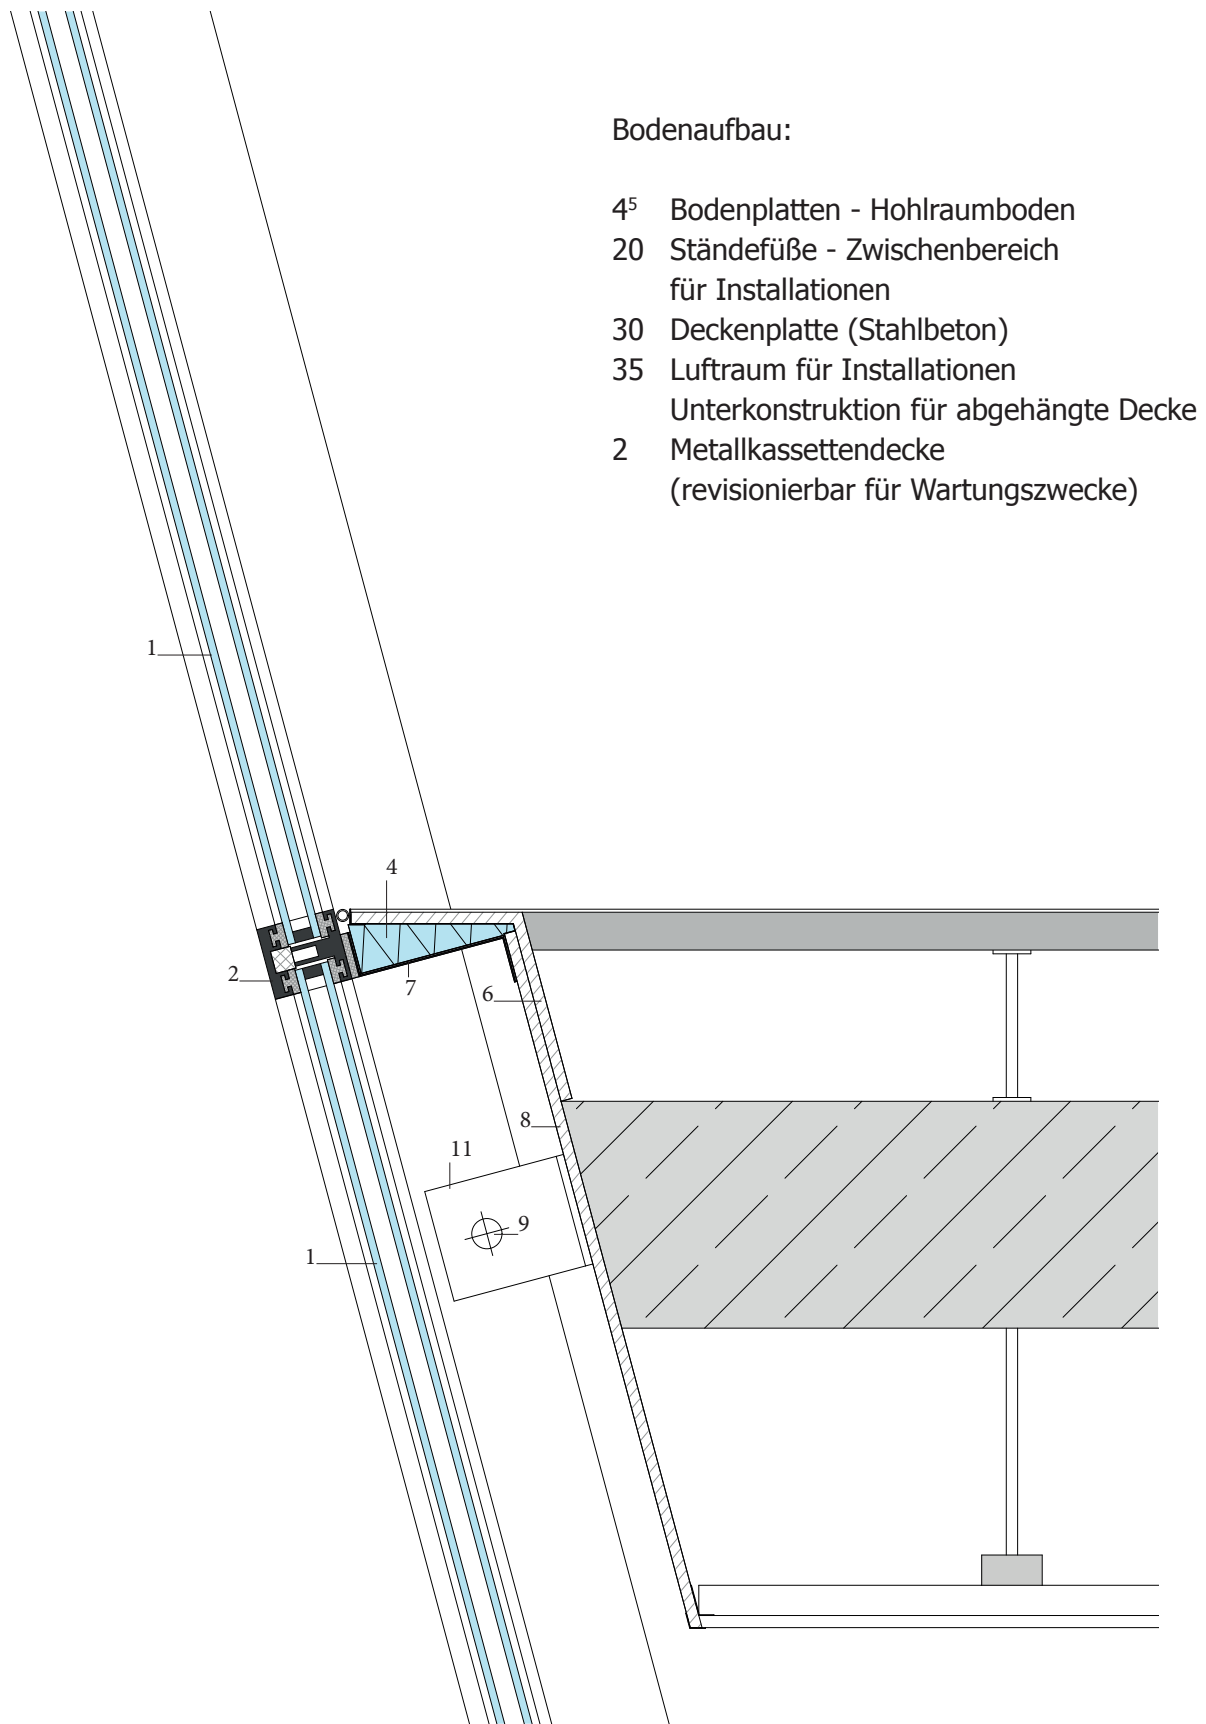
Fassadenschnitt 2D - Regelgeschoss
